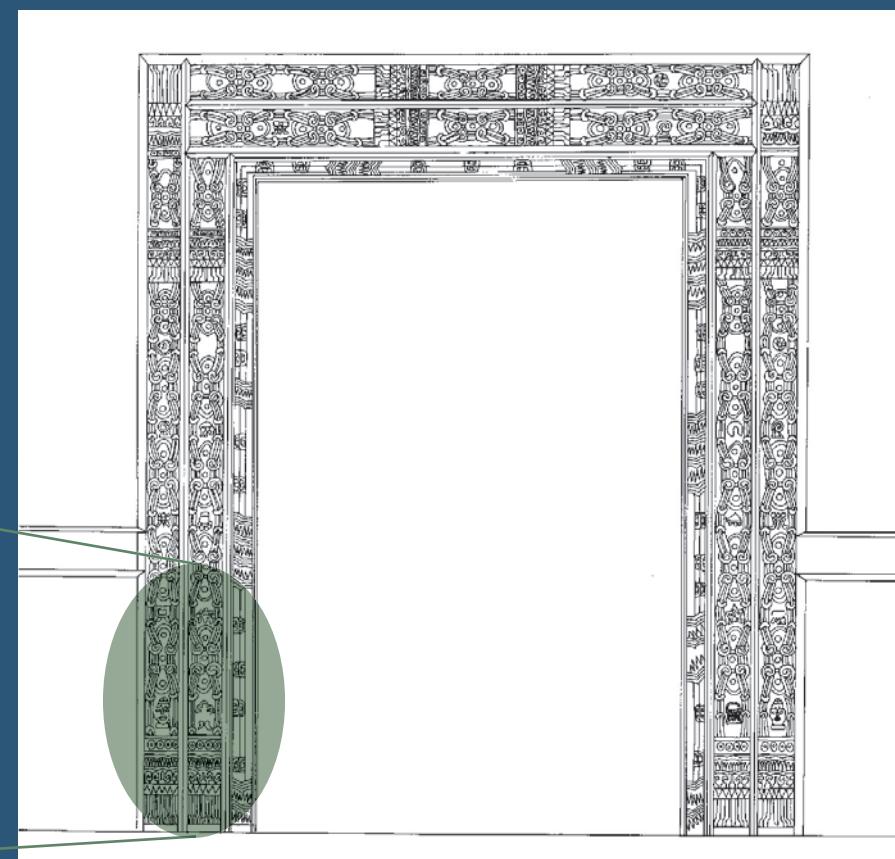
Reconstrucción arquitectónica del Patio 25 (borrador).
